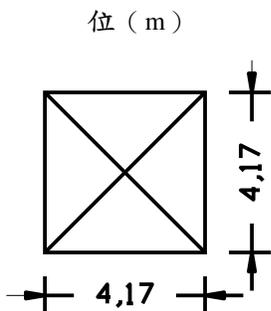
自屋凸頂往上 3m 之通訊鐵塔平面示意圖 單位 (m)
